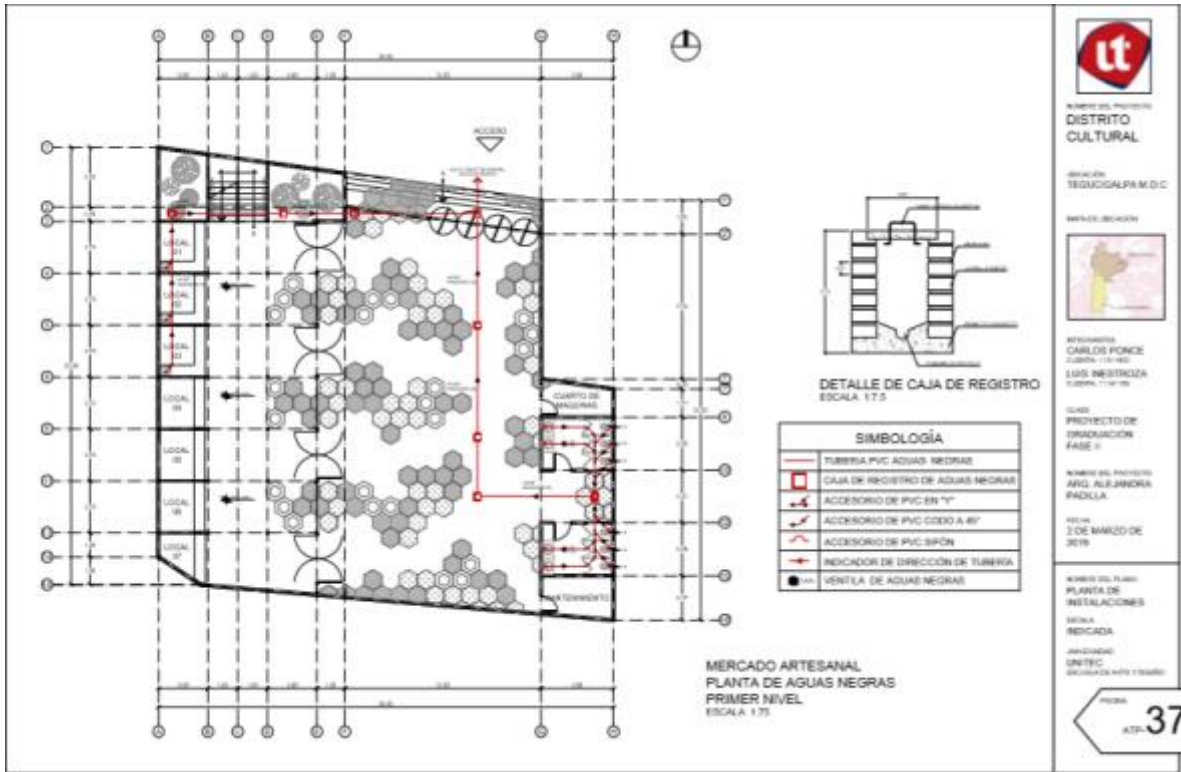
Planta de Aguas Negras Mercado Artesanal
